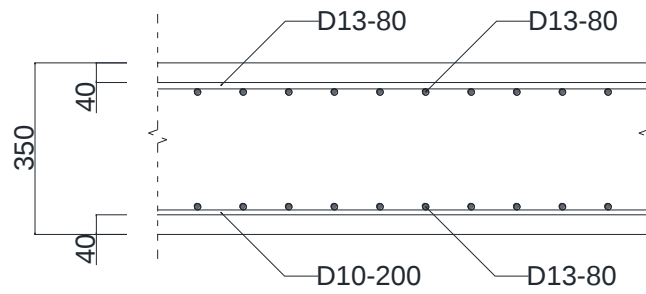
Potongan arah melintang balok *crane* dan balok lajur
